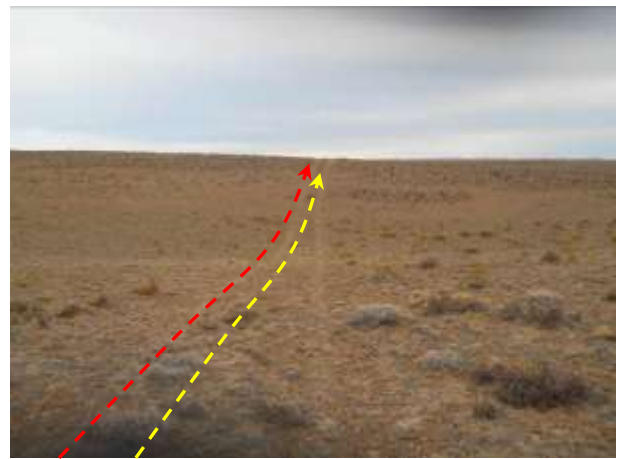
Emplazamiento de ductos por picada revegetada. Foto en dirección SE.
